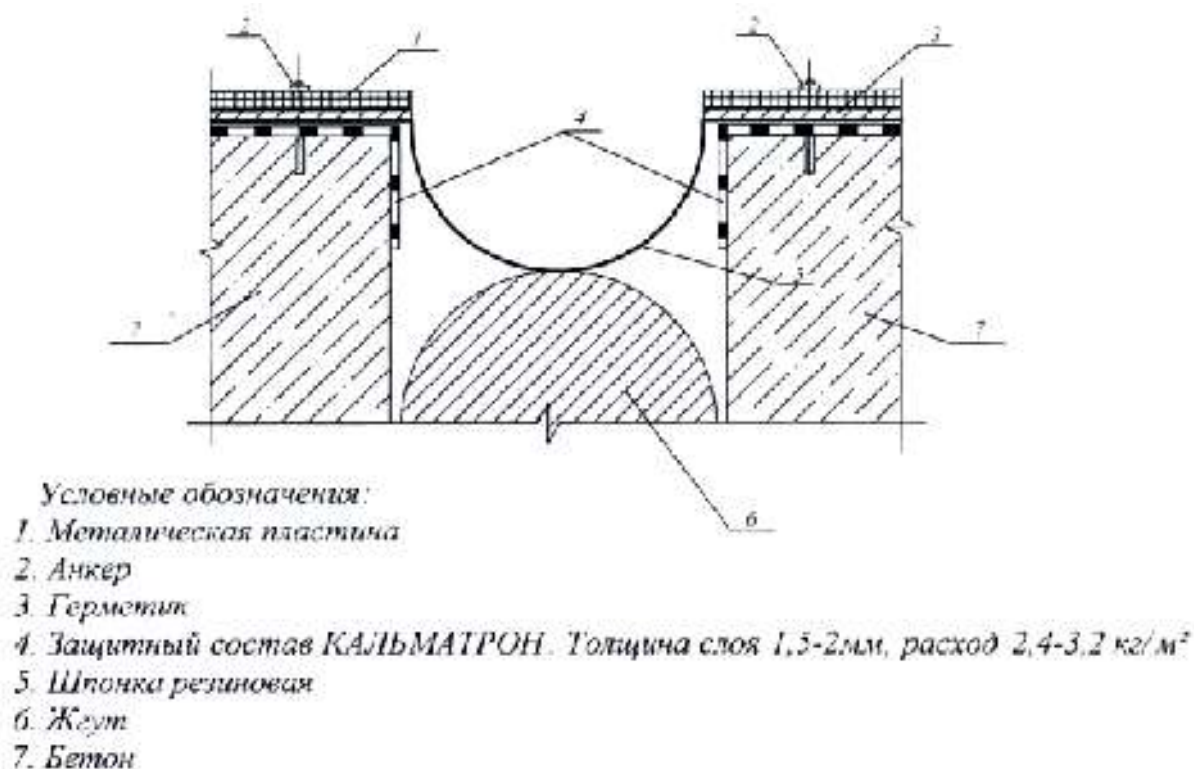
Конструктивное решение по устройству гидроизоляции деформационных швов снаружи строительной конструкции
